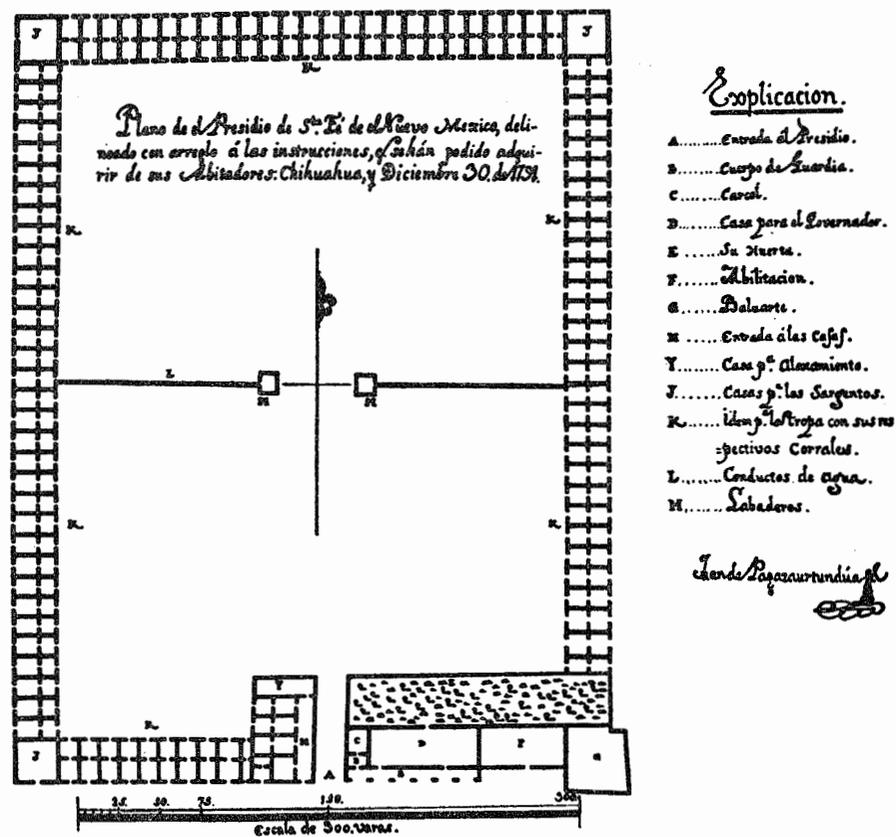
Grundriß des Presidios in Santa Fe. Plan von 1791
